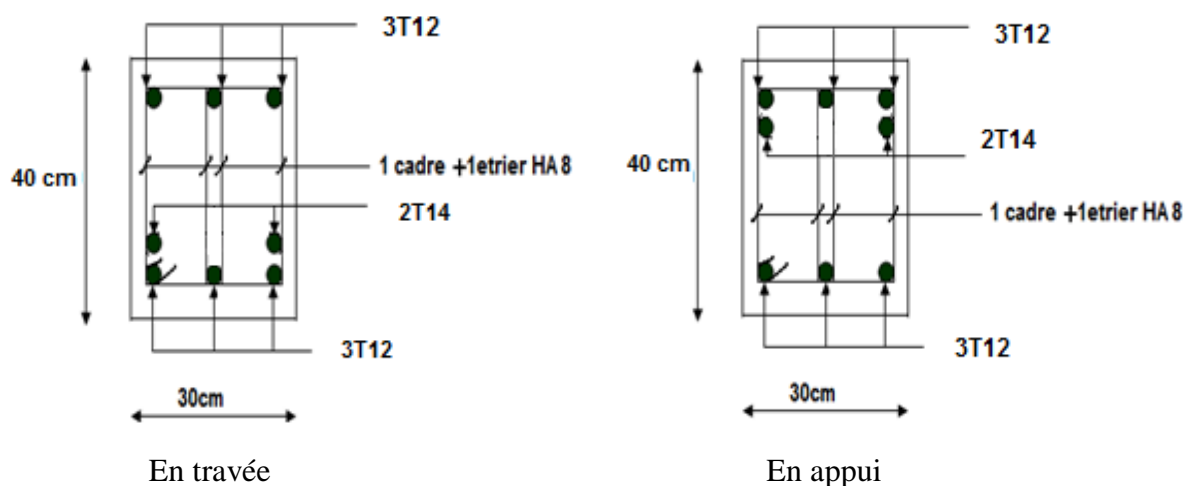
ferraillage des poutres secondaires (30x40) de niveau 6,12 m
